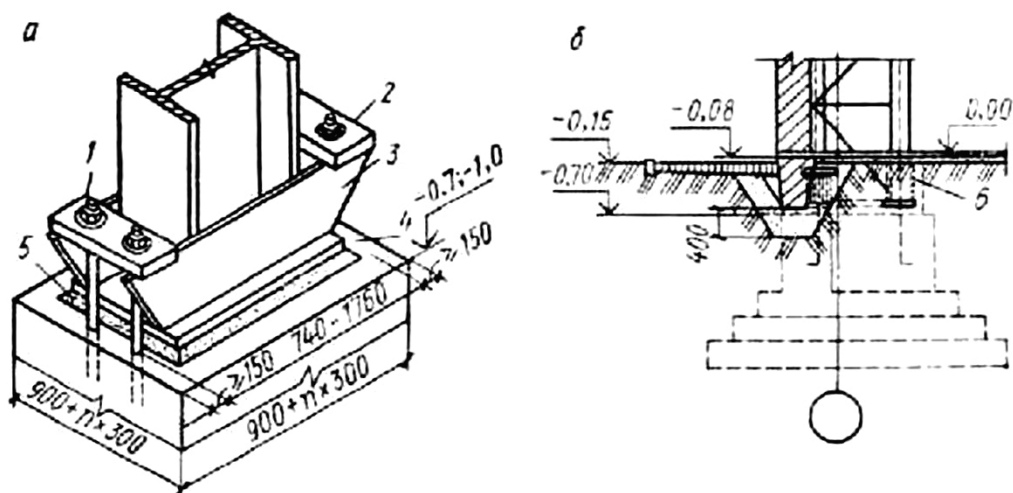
Базы (башмак) колонн и опирание их на фундаменты:
